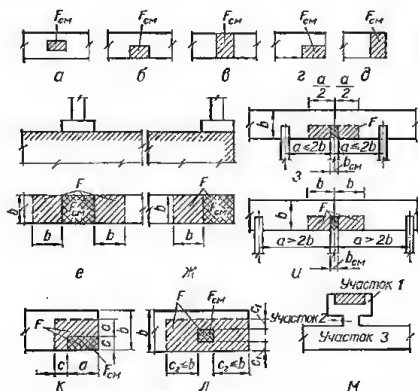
К расчету сечений элементов на местное сжатие (смятие):
